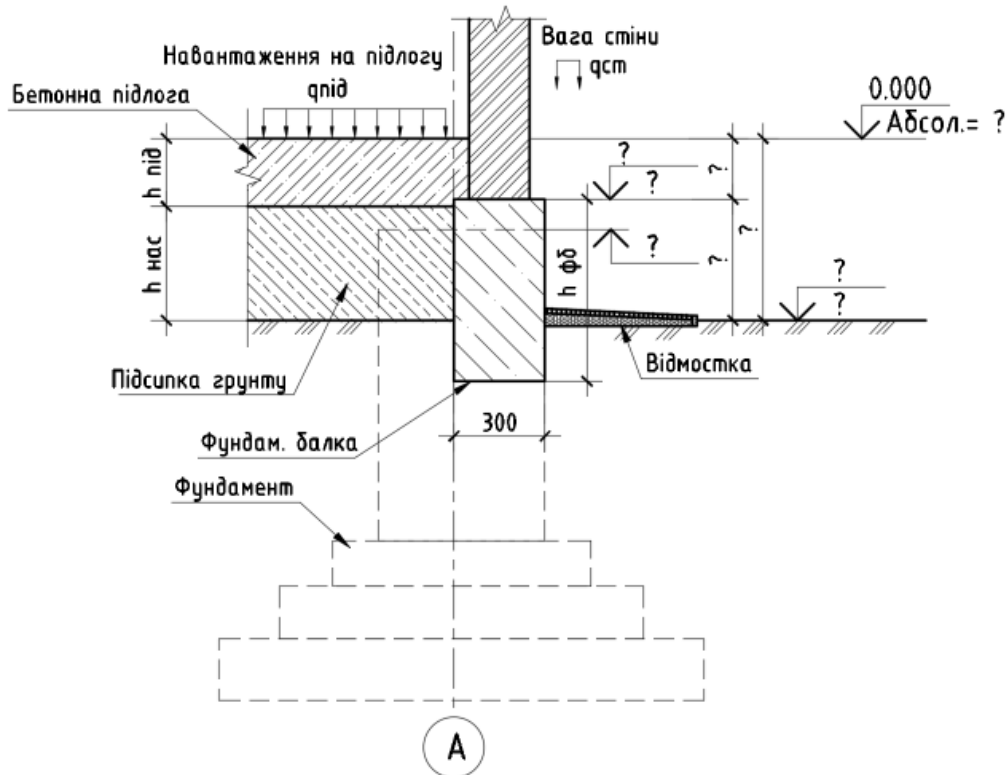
Розрахункова схема до фундаменту неглибокого закладання та додаткові навантаження, що діють на фундамент.
